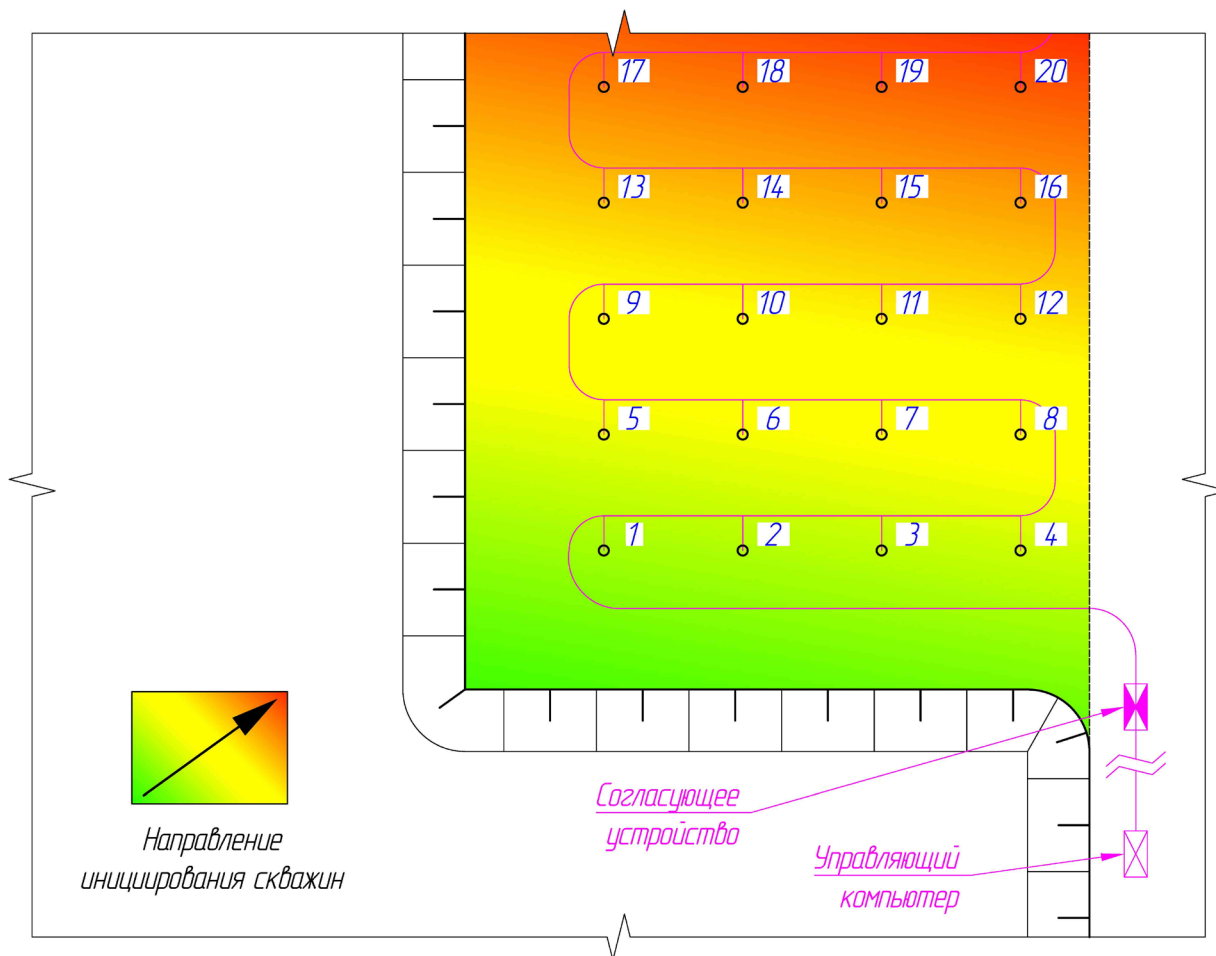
Поперечная схема монтажа поверхностной взрывной сети (вариант 3)
